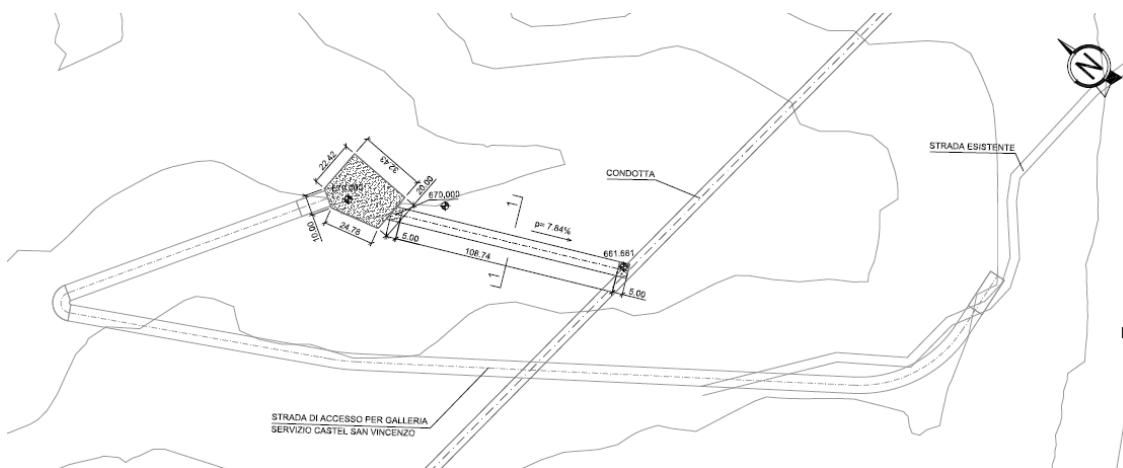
Pianta Galleria Di Accesso Al Cantiere Castel San Vincenzo
